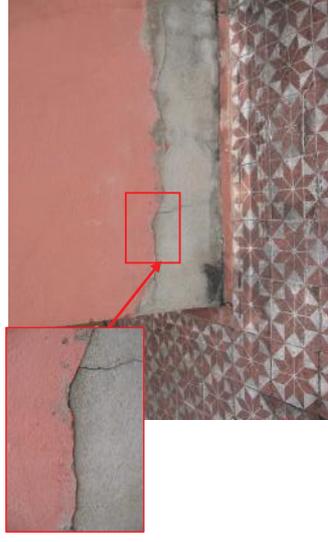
Fissuras por movimentação térmica na parede da sacada frontal.
